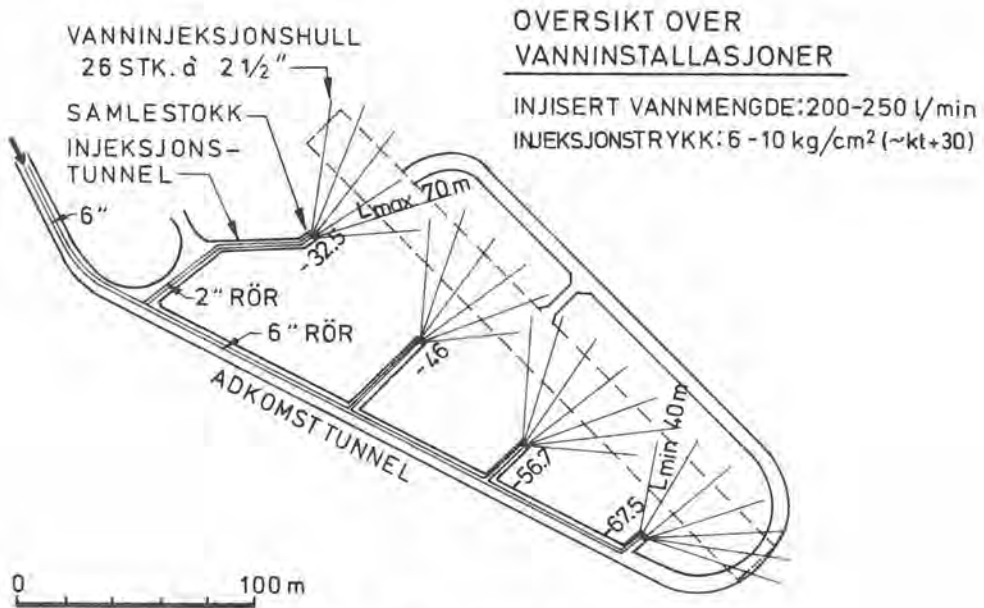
Plan for injeksjon av vann over lagerhallen.
